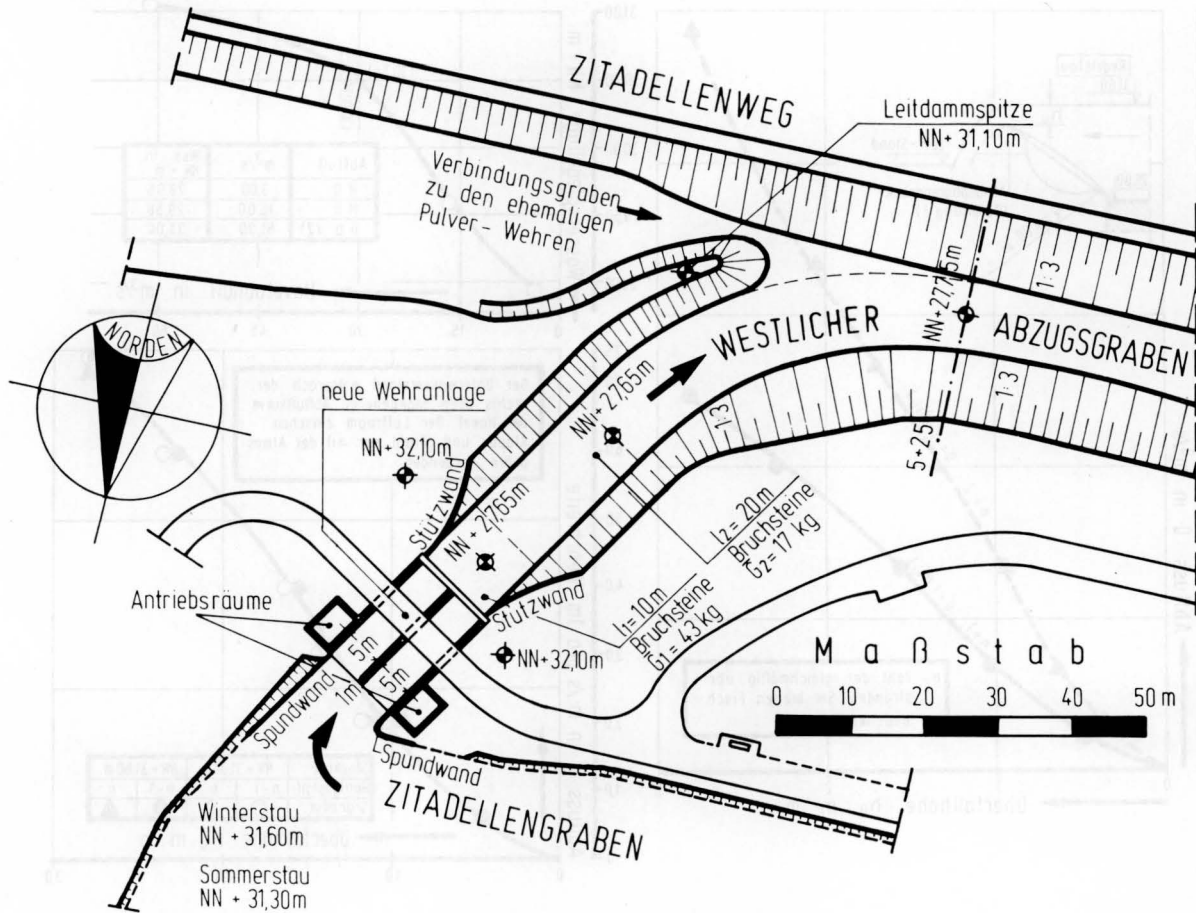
Grundrißgestaltung der Bauwerke im Wehrbereich mit der Verbindung zum Westlichen Abzugsgraben - Ausführungsvorschlag
